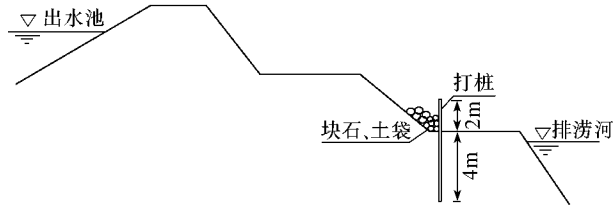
裂缝及堤身滑移抢险施工示意图
